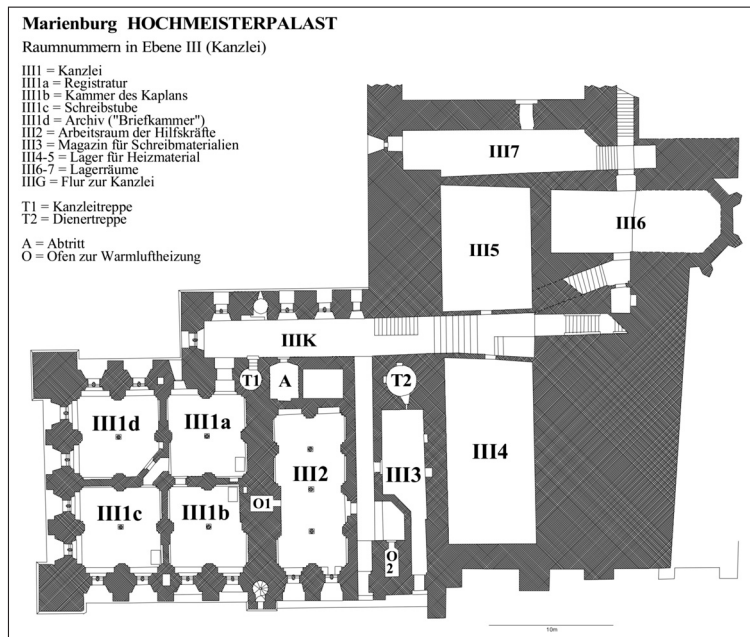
Grundriss von Ebene III (Kanzleigeschoss) mit Angabe der Raumnutzung
